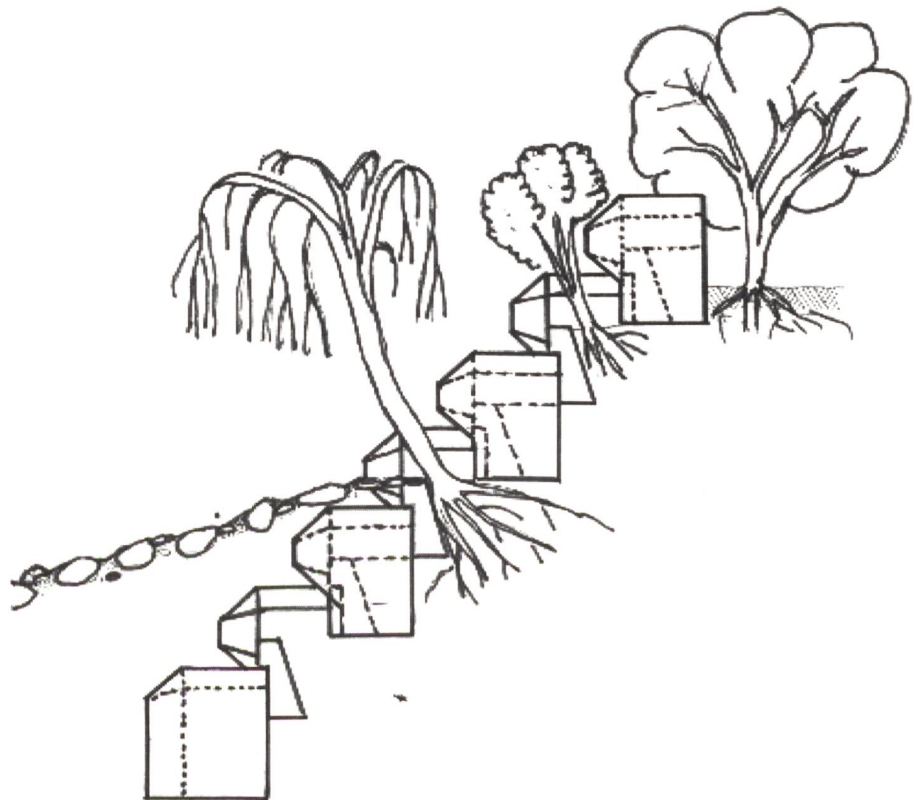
Blockmauer aus an Ort erstellten, unarmierten Betonblöcken (1 m³) mit Lücken für Bewuchs (gemäss Dénes [5]).
